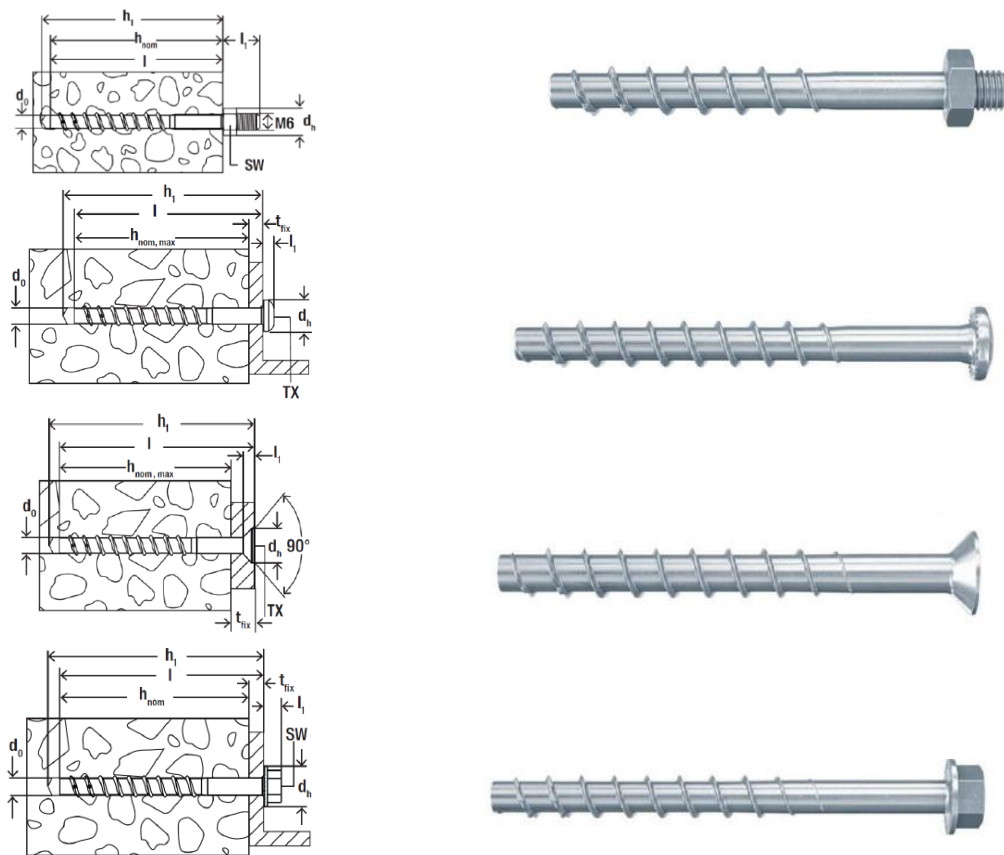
Eingebaute Betonschrauben mit unterschiedlichen Kopfformen (links) und Foto der Schrauben (rechts).
